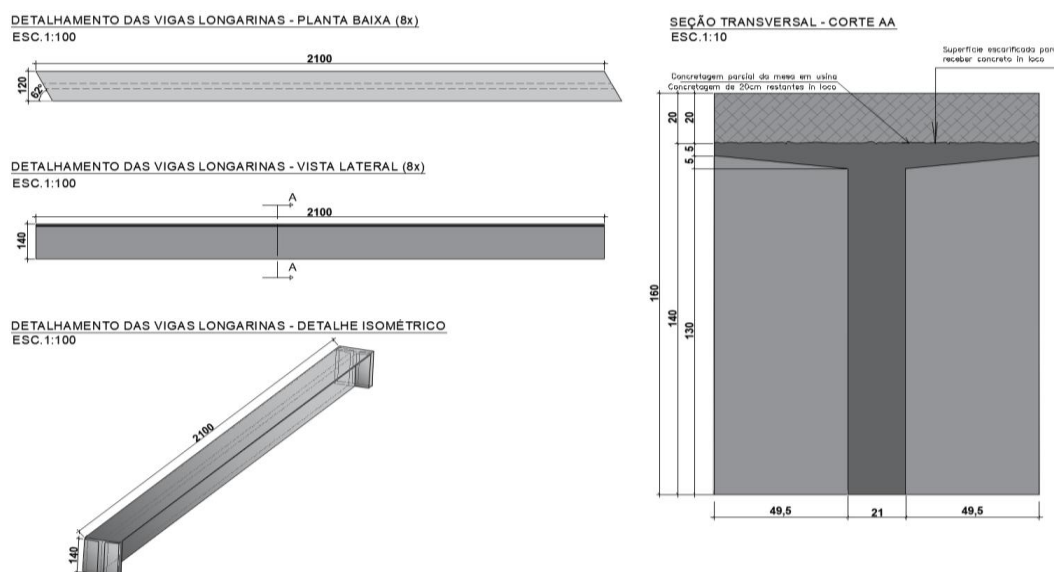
Vista detalhamento das vigas longarinas do Projeto Básico da Ponte localizada no futuro Contorno de Santa Maria de Jetibá / ES.
